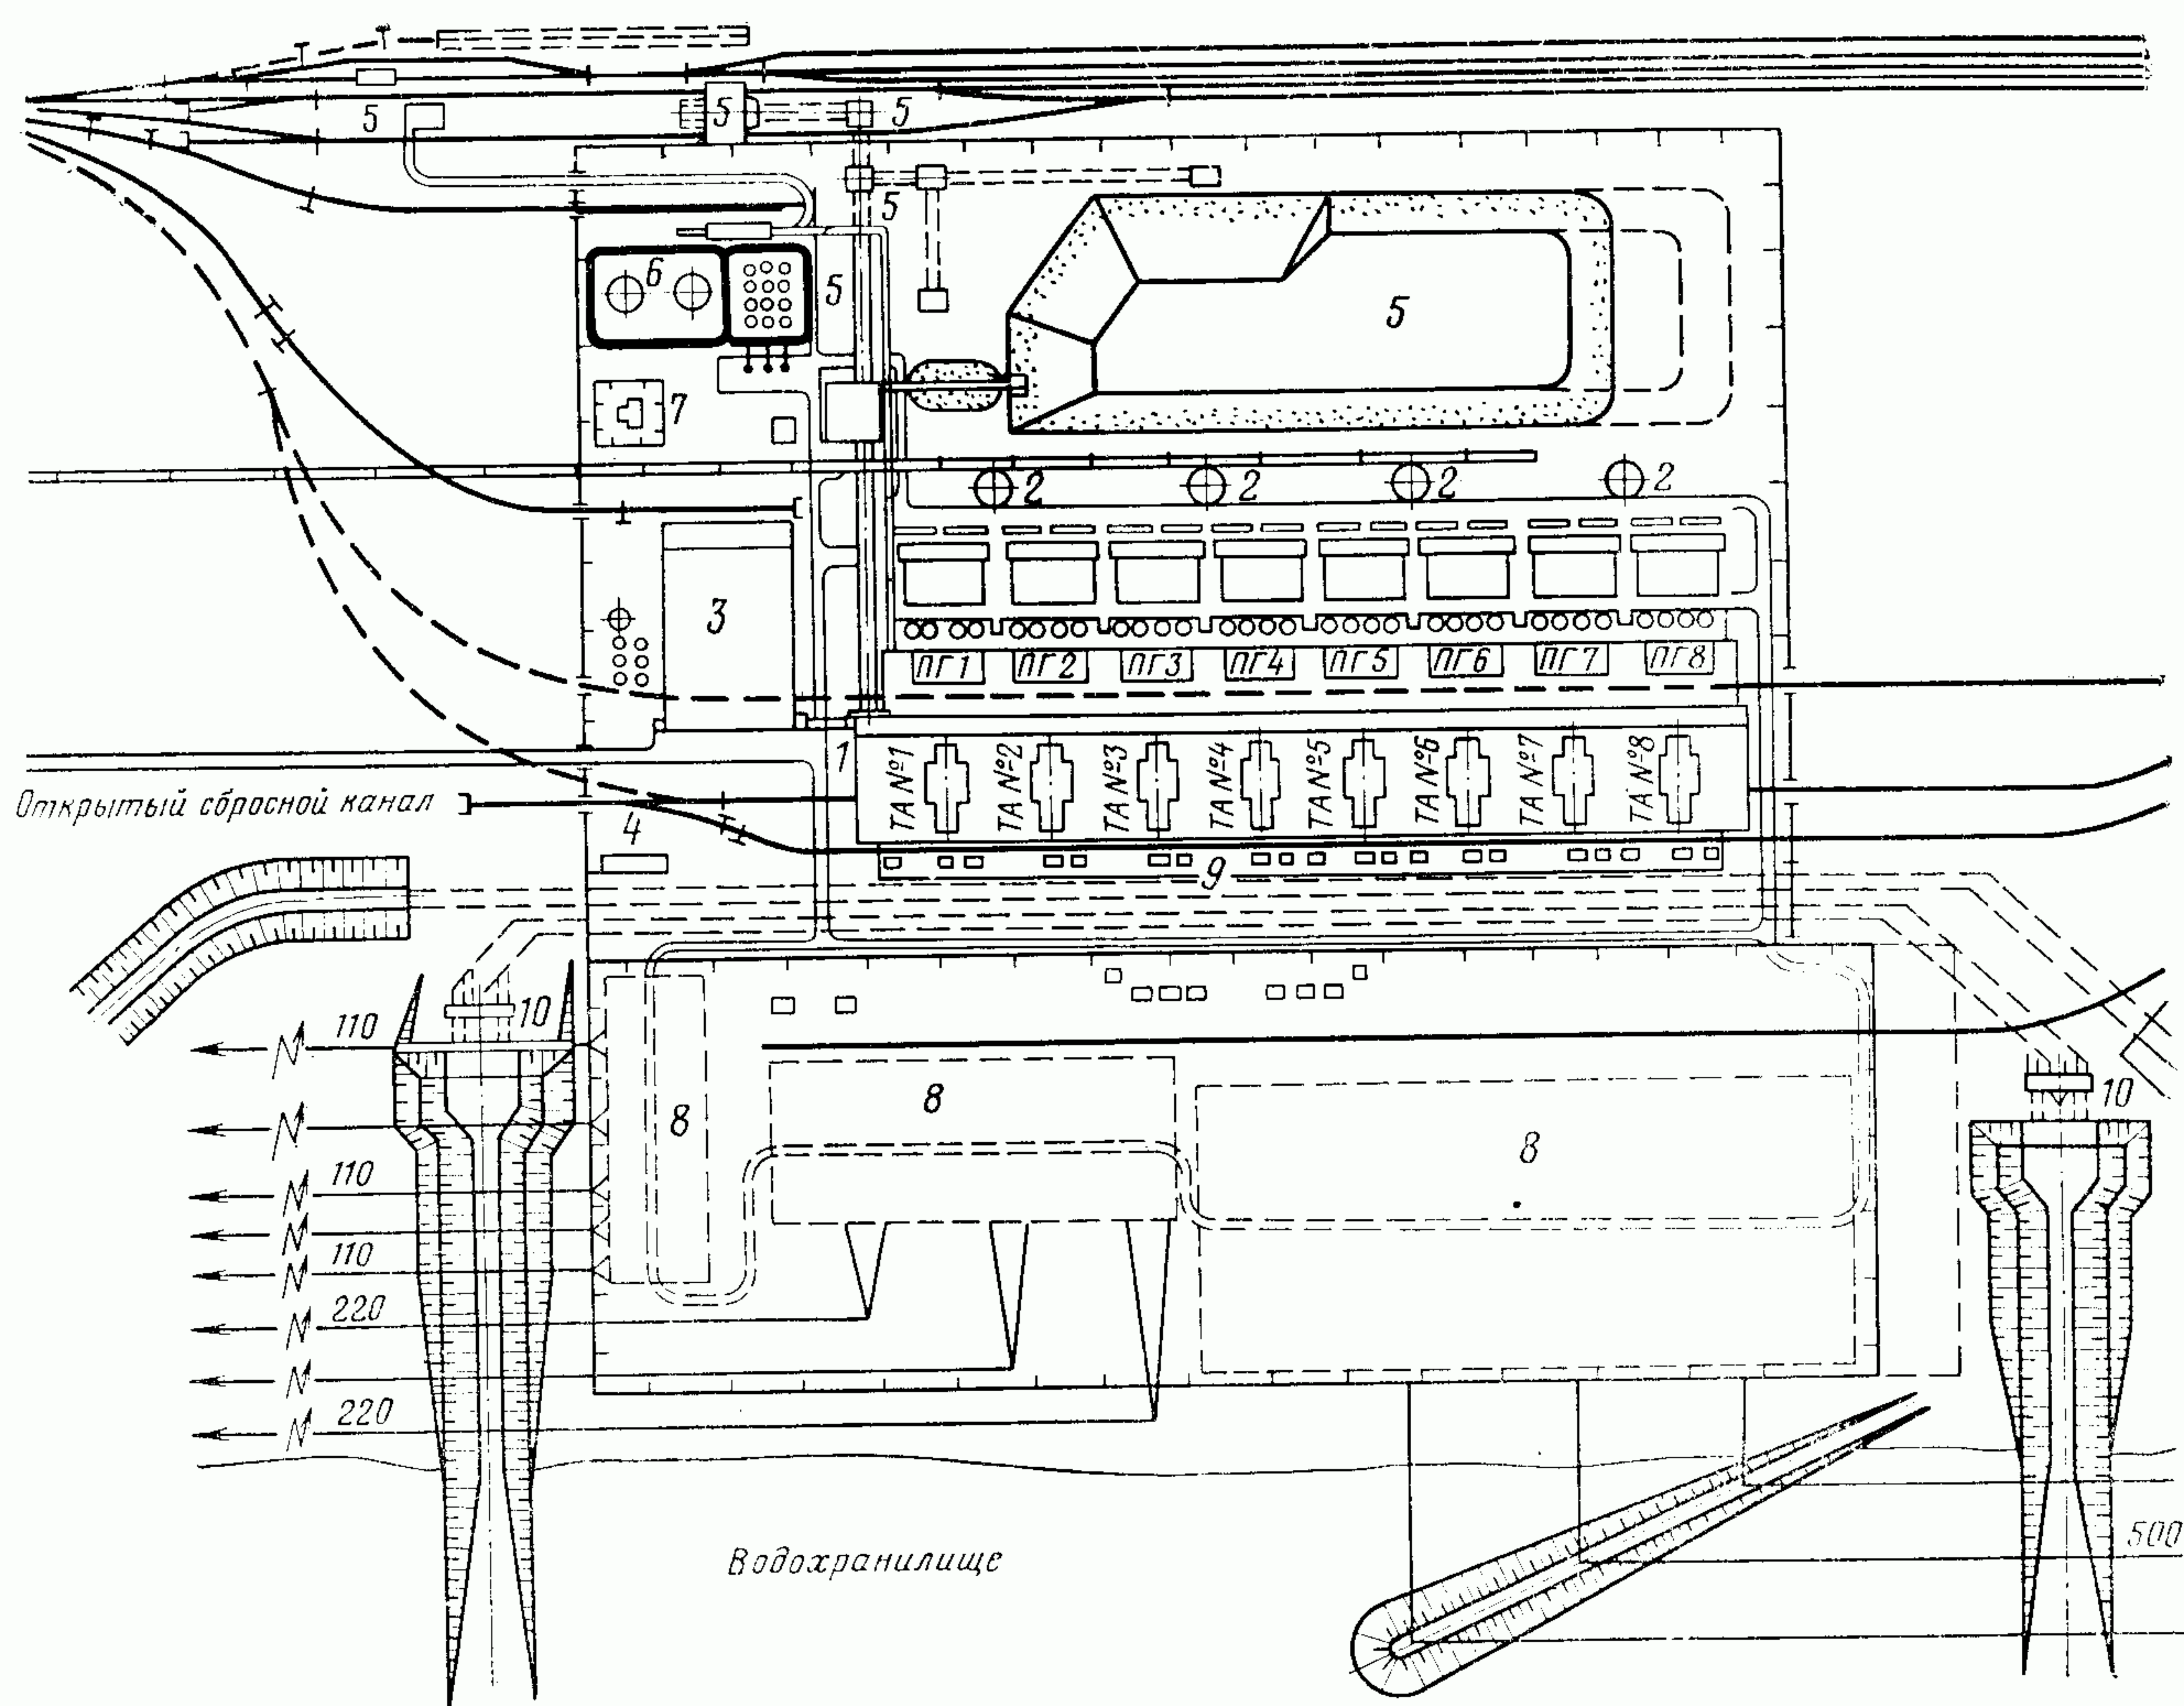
Генеральный план типовой пылеугольной электростанции 2400 МВт с размещением открытого распределительного устройства (ОРУ) перед фронтом машинного зала.
